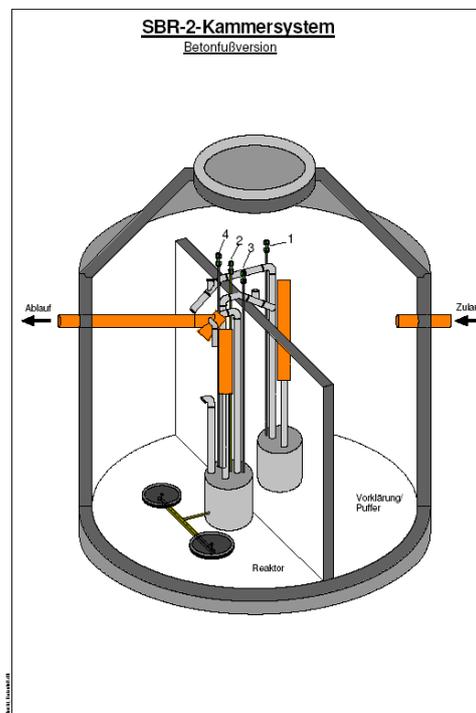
Schemazeichnung SBR-2-Kammersystem, Betonfußversion
